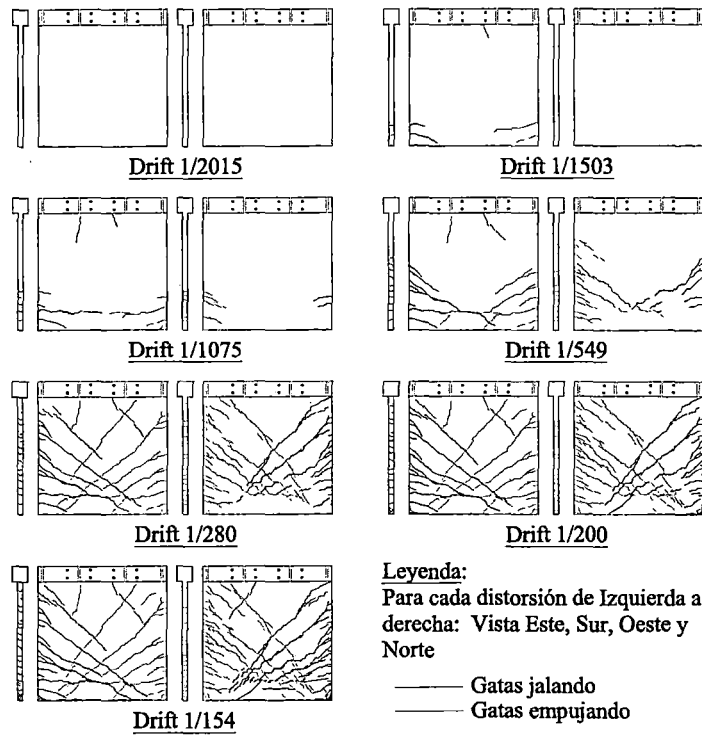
Propagación de grietas en espécimen 02.
